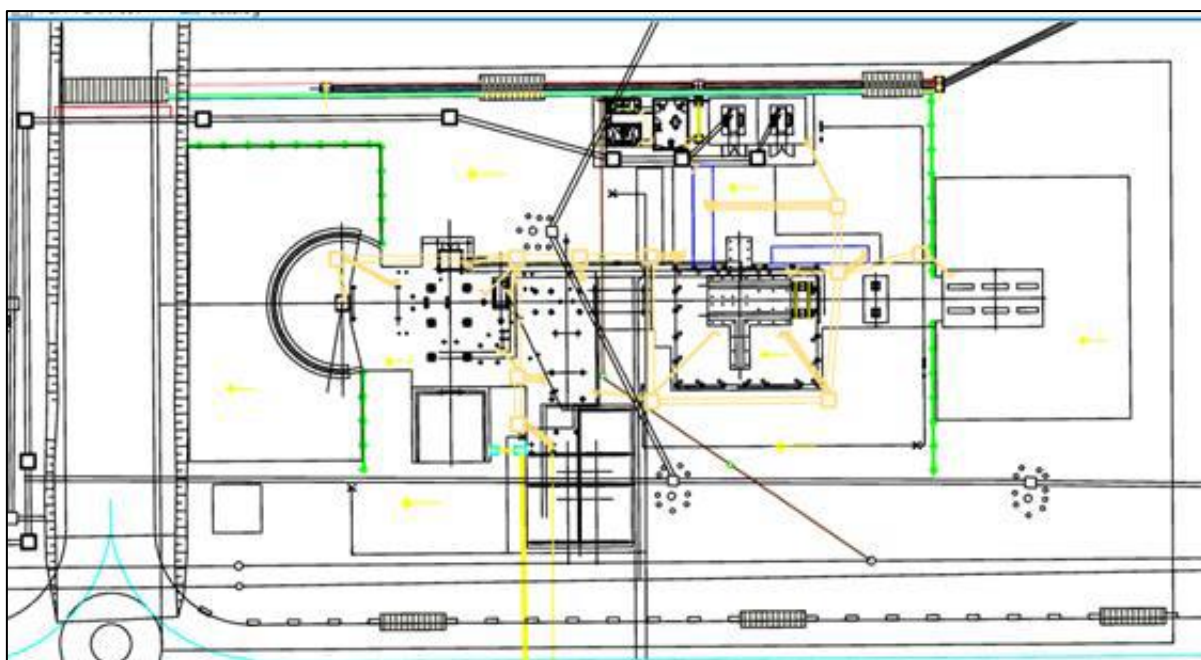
Projeto Executivo da Planta Shredder, para reciclagem de sucata ferrosa. Fonte: Caracterização Sucinta do Empreendimento – Planta Shredder
